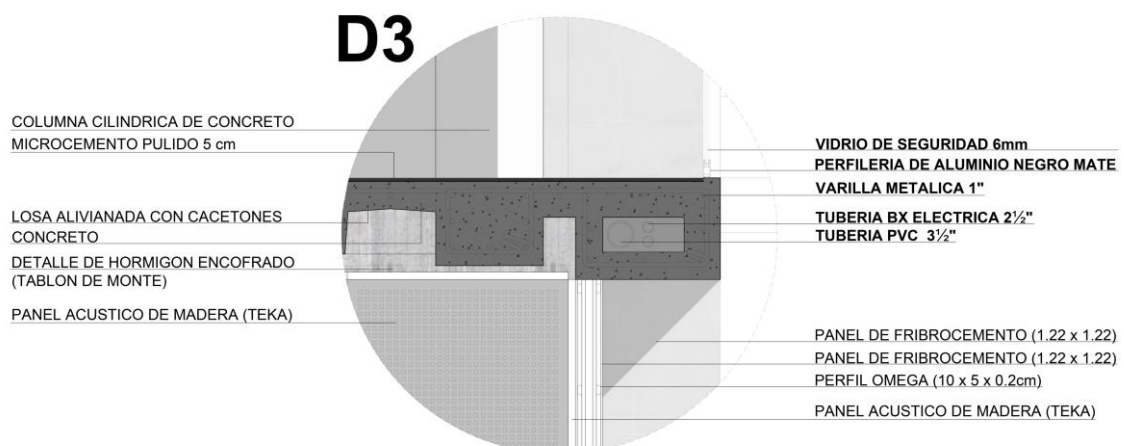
Detalle 3. Corte por fachada 1. Elaboración propia.
